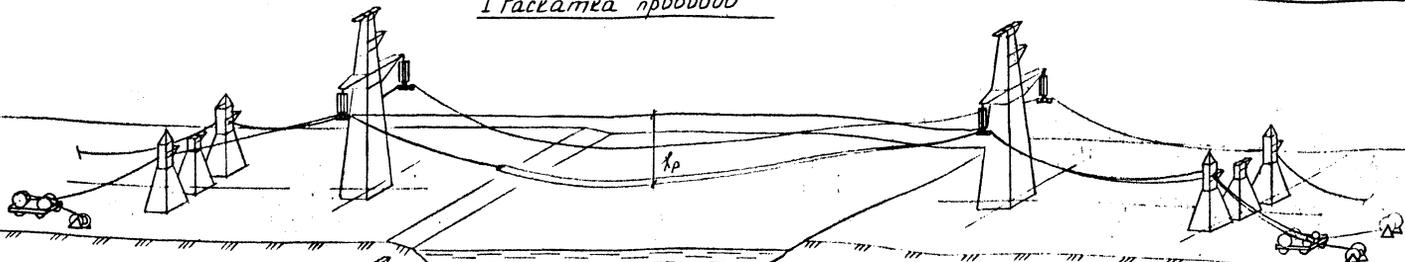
Схема расчета длин проводов, монтируемых методом отмера
